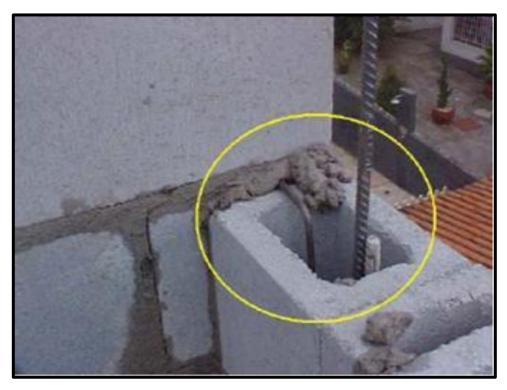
Armadura vertical utilizada na alvenaria estrutural com aplicação de grout. (Fonte: www.lnf.ufrgs.br)
